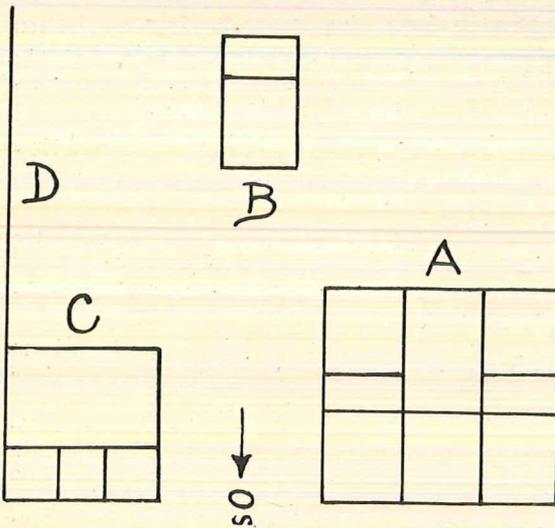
Lageplan des Hauptbaues und zweier Nebengebäude im westlichen Teil des Tempelbezirks bei Gerolstein. Nach einer Skizze von Baurat Seyffarth.
